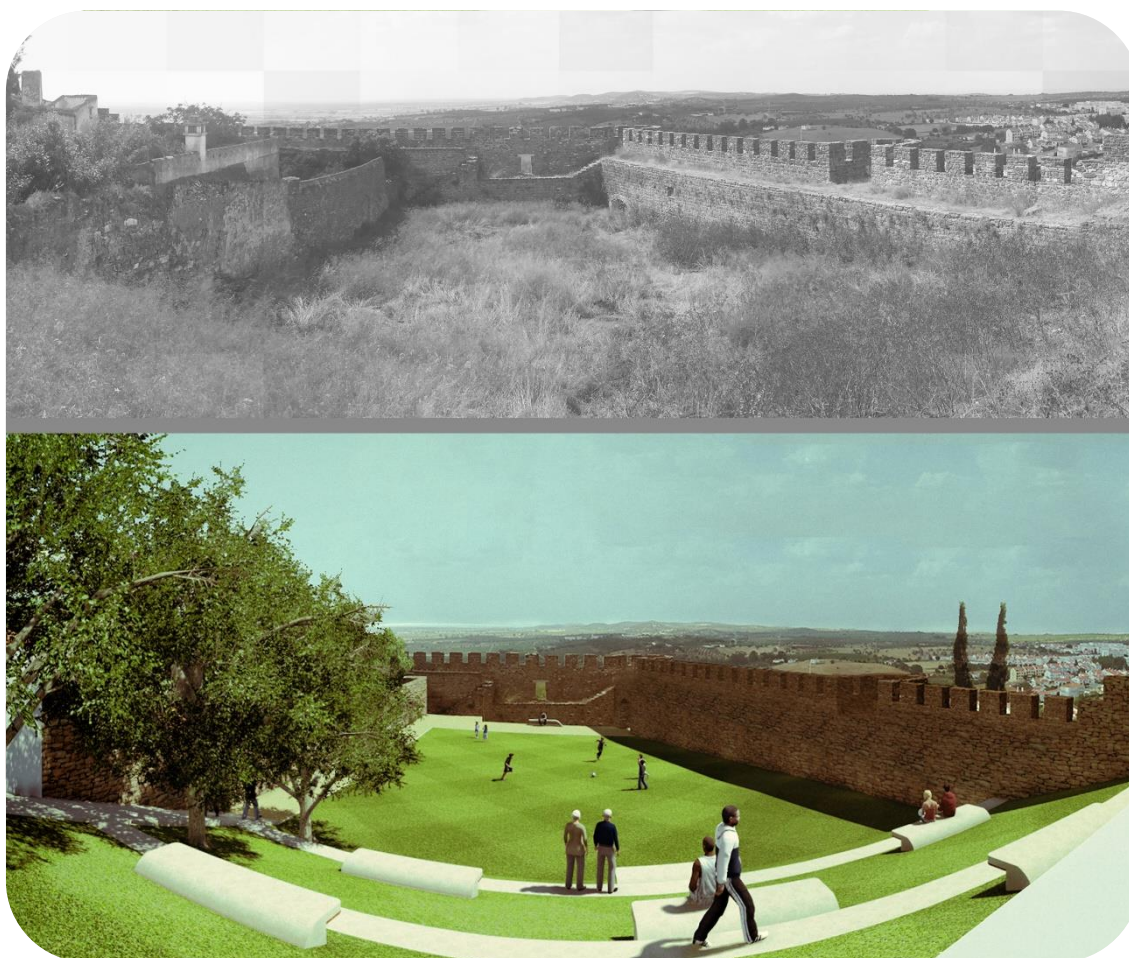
Imagem atual e da proposta para o Jardim da Capela da Rainha Santa
